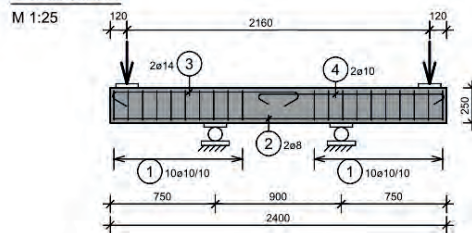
Abmessungen und Bewehrung der Ergänzungsversuche
